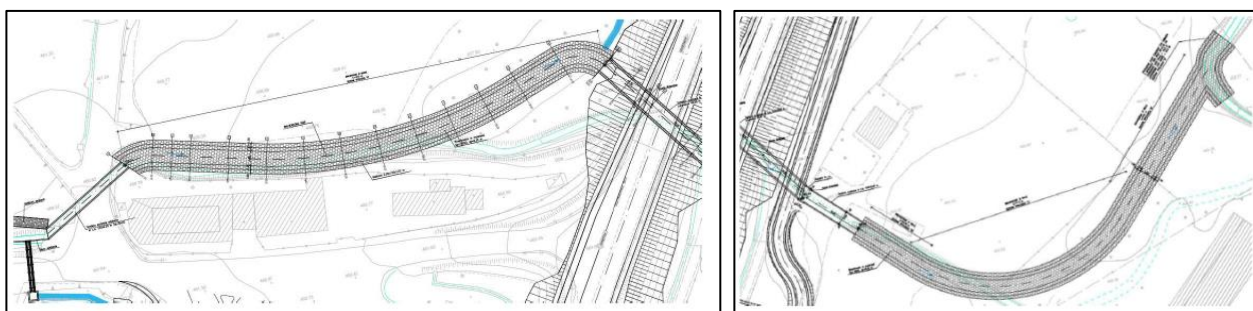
Deviazione tracciato IN37 e stralcio planimetrico
